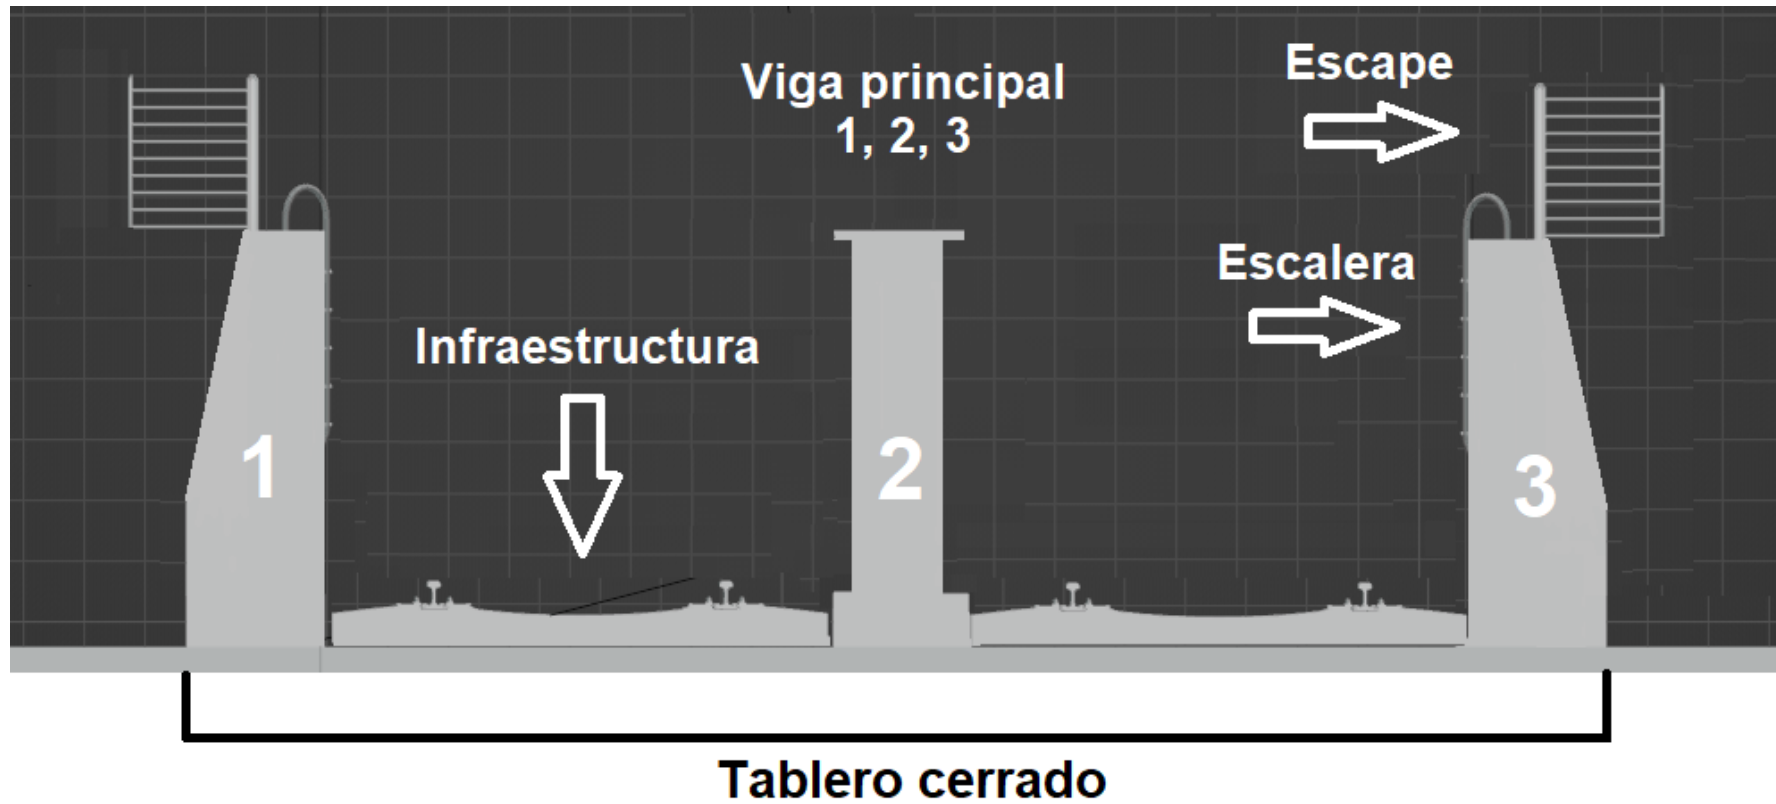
Corte transversal del puente de Luján sobre la ruta Nacional número 5. Fuente JST
